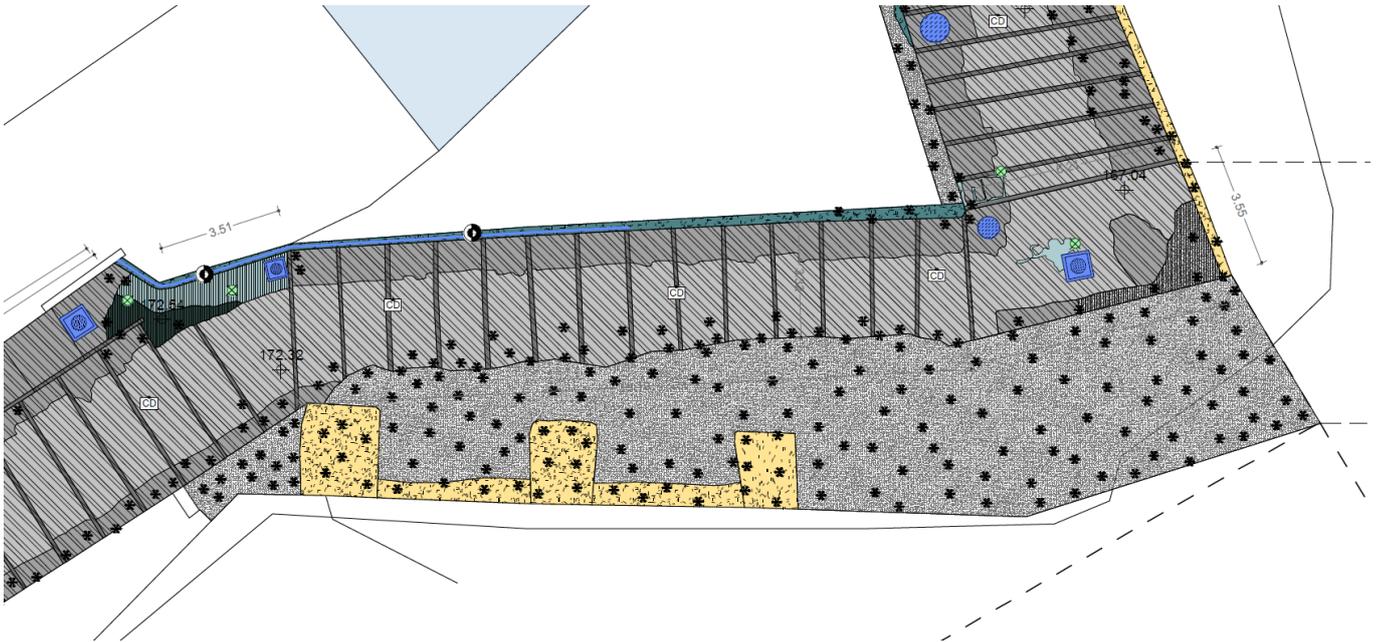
stralcio planimetrico dello stato di conservazione - (elaborato GKE015e/00)
